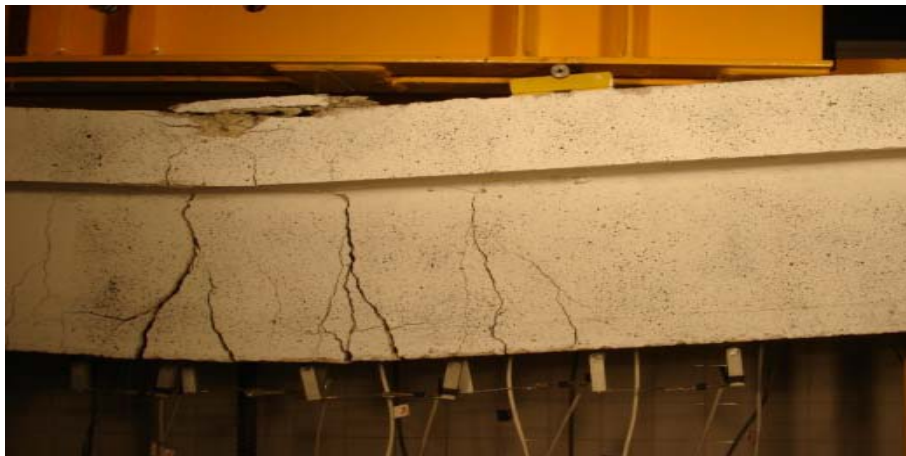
Pormenor da deformação e da fissuração da viga TSC2 (EBR) junto a uma das zonas de aplicação da carga
